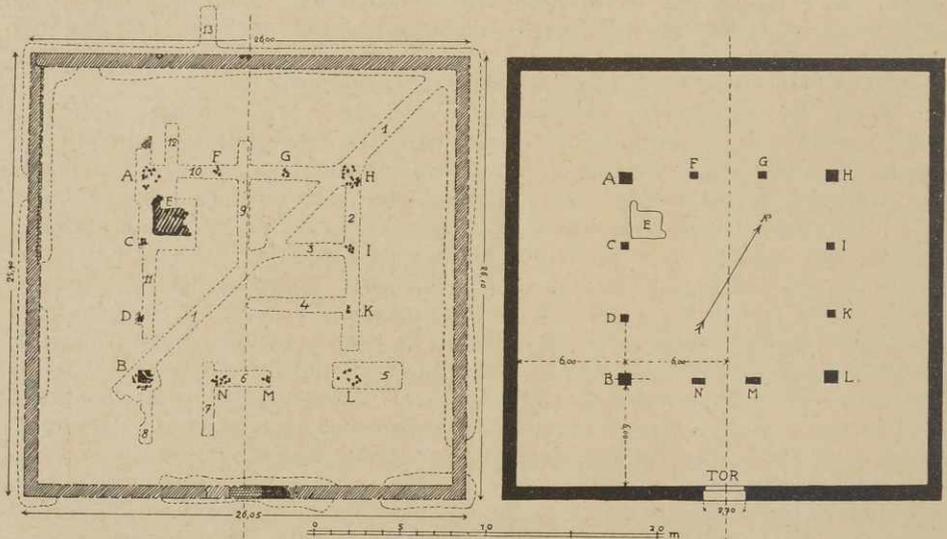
Befund und Grundrißschema des römischen Gebäudes im Rotwildpark bei Stuttgart.
